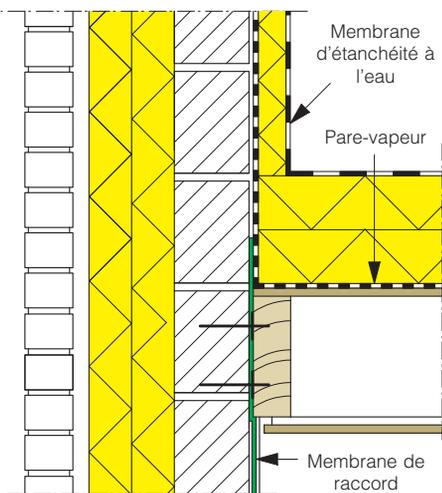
et 7 Ancrage des poutres aux murs porteurs à l'aide de sabots
